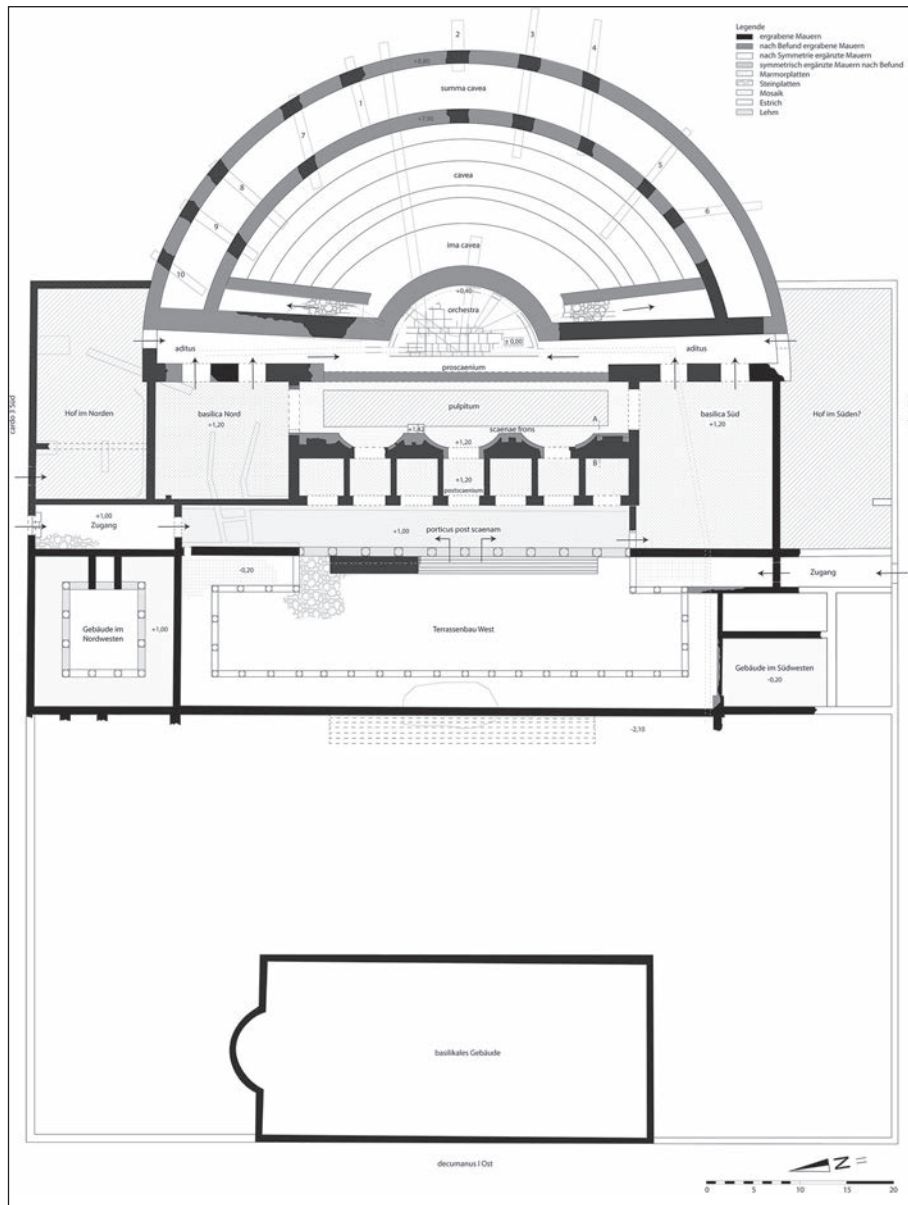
Grundriss des Bühnentheaters mit vorgelagertem basilikalem Gebäude (nach Dolenz 2020c, Abb. 1).
